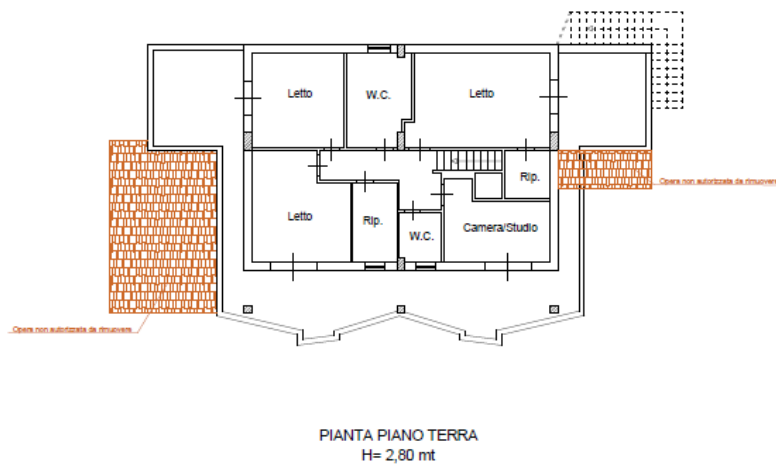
PLANIMETRIA PIANO TERRA (in allegato)
